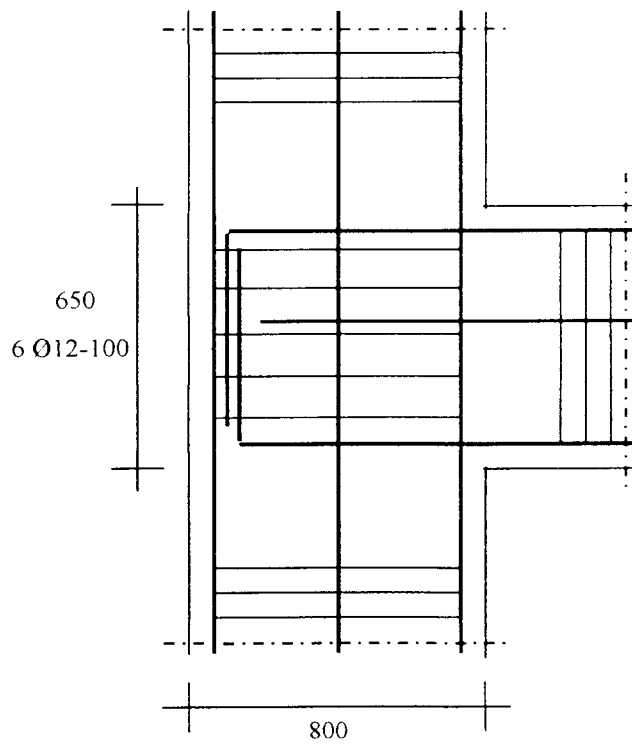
Detail join Balok Kolom D Lantai 12
